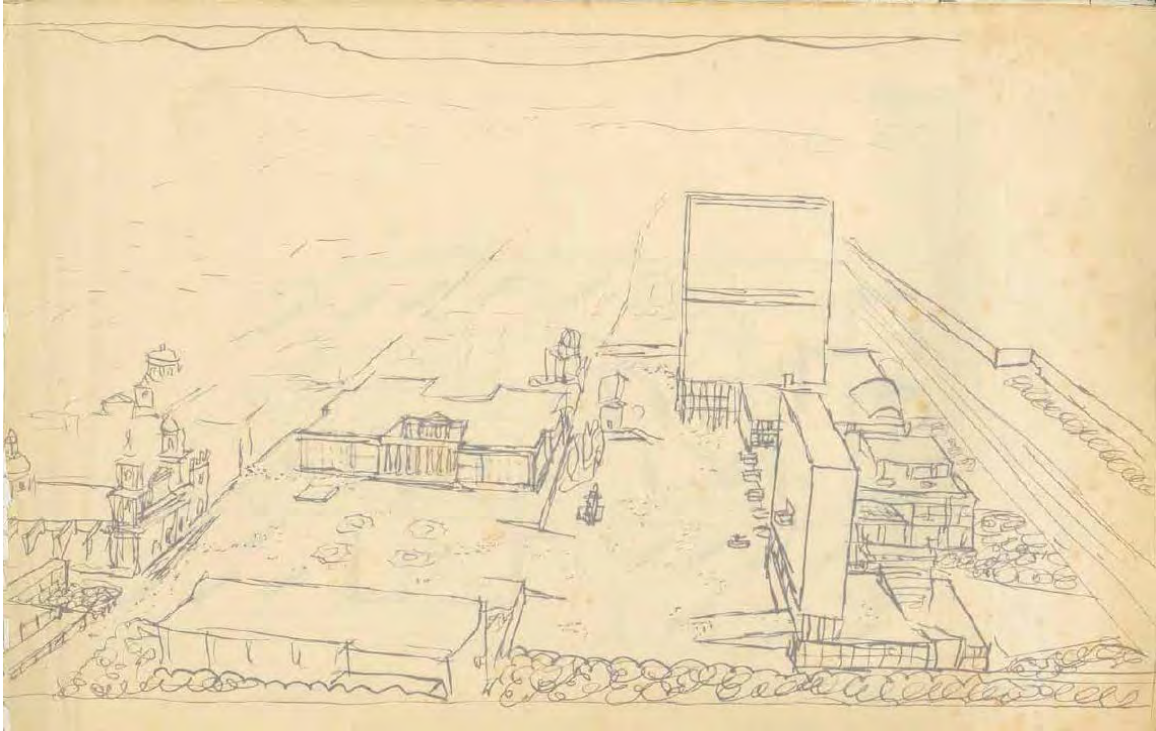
Centro Cívico: Plan Piloto de Bogotá.
